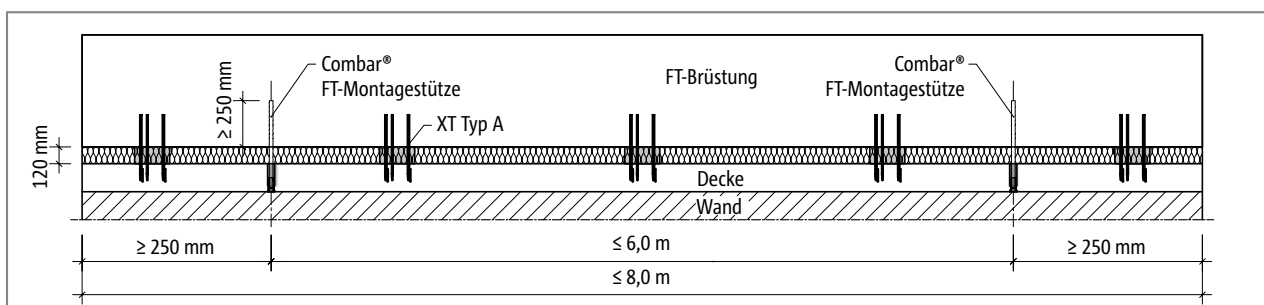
Schöck Isokorb® XT Typ A mit Combar® FT-Montagesätze: Randabstände und Mindesteinbindelänge in der Fertigteilbrüstung
